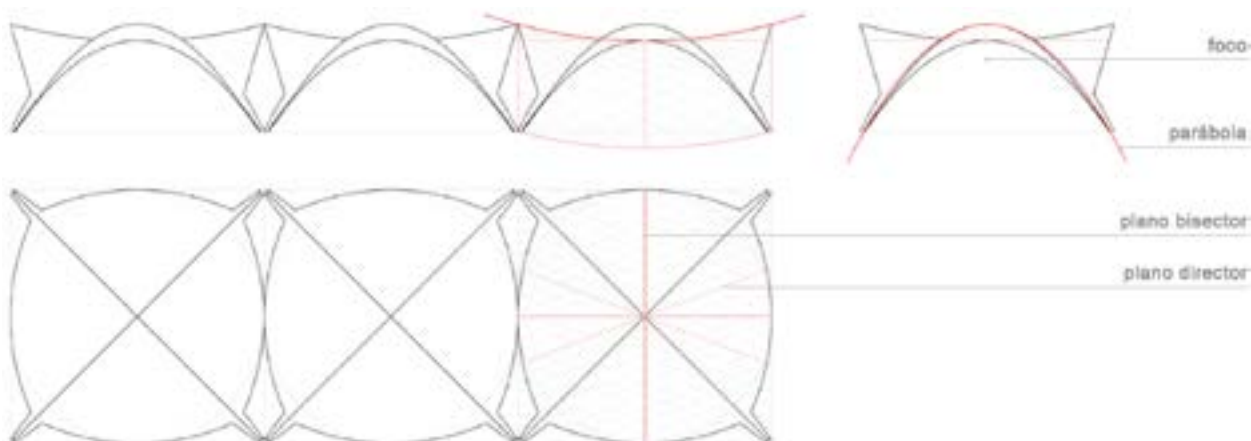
Esquema de planta y alzados de embotelladora Bacardí, Tultitlán, México, Félix Candela, 1960. Dibujo de los autores.
